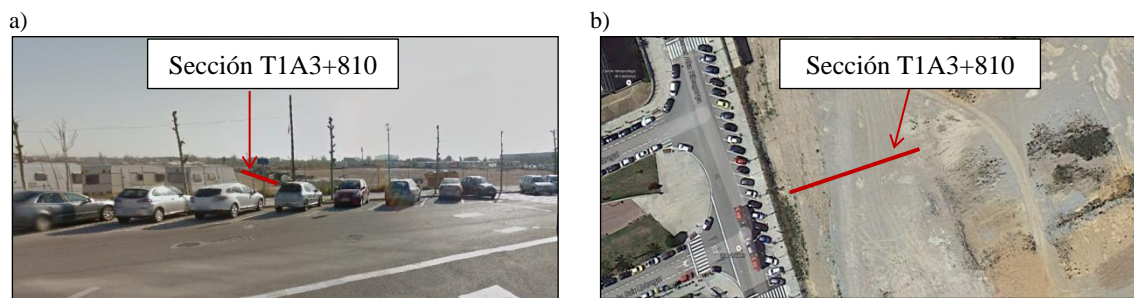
17. a) Vista desde satélite en alzado b) Vista desde satélite en planta, sección T1A PK 3+810. Fuente: Google Maps
